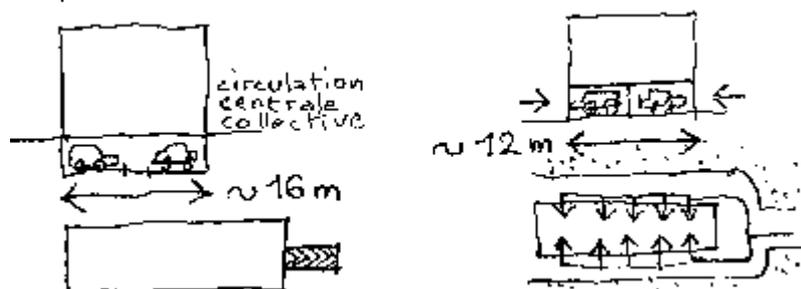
Les entrées de boxes par les façades amincissent le parking.
